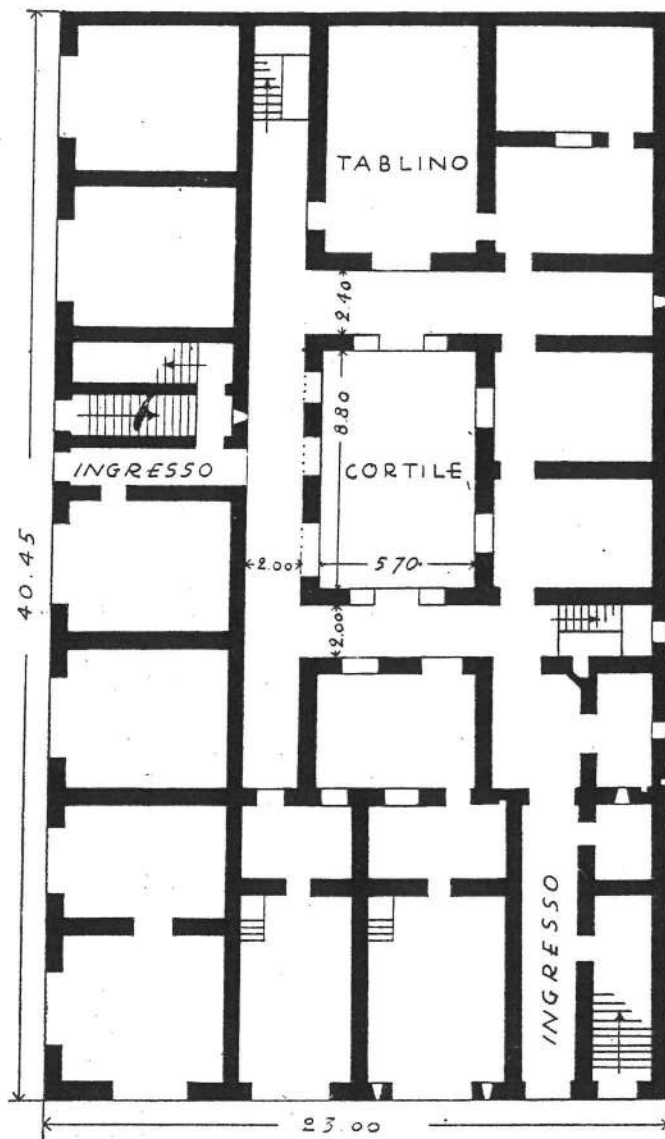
CASA DETTA DI DIANA: PIANTA
